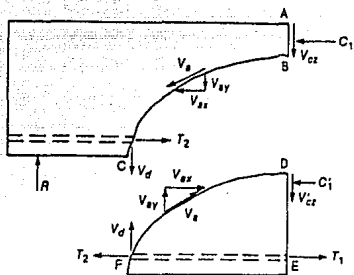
Fuerzas internas en una viga agrietada sin estribos (Ref. 3)
